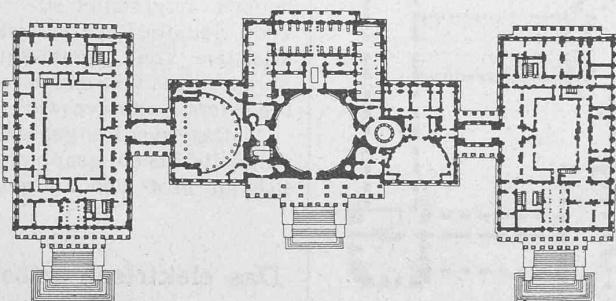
Washington. — Grundriss vom Kapitol. 1:2500.
